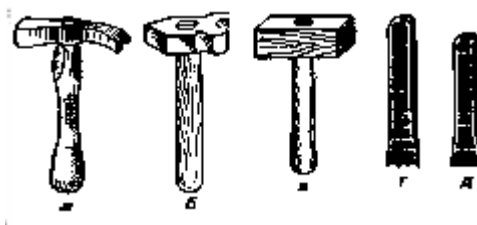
Інструменти для підготовки поверхонь під штукатурення:
